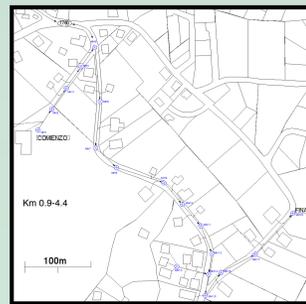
DISEÑO DEL ALCANTARILLADO SANITARIO
